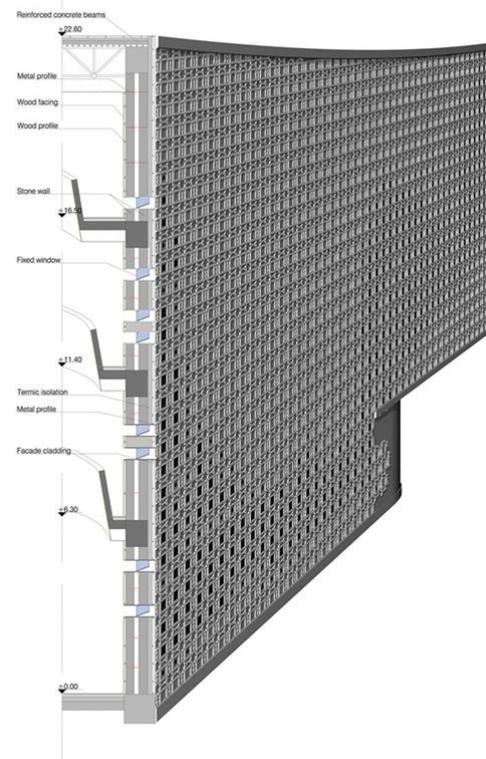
le détail de la façade. Source : Pinterest « Maden group »
